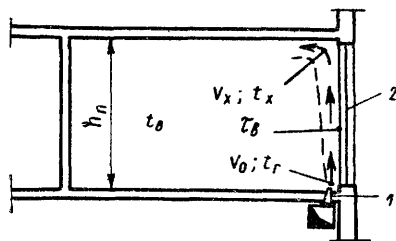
Центральное воздушное отопление помещения с подачей нагретого воздуха через напольный щелевой воздухораспределитель 1 вдоль наружного ограждения 2
